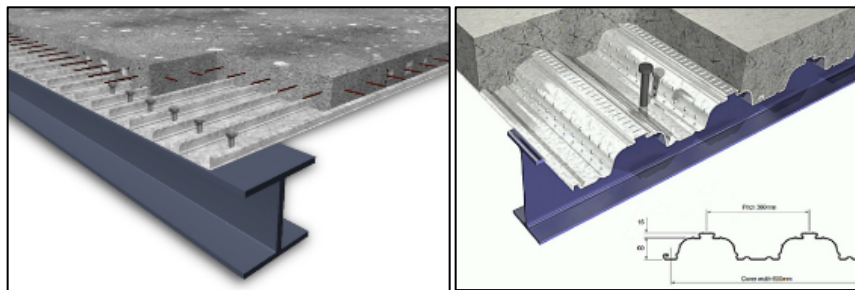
Sistema de entrepiso de losa compuesta con presencia de Steel deck.
